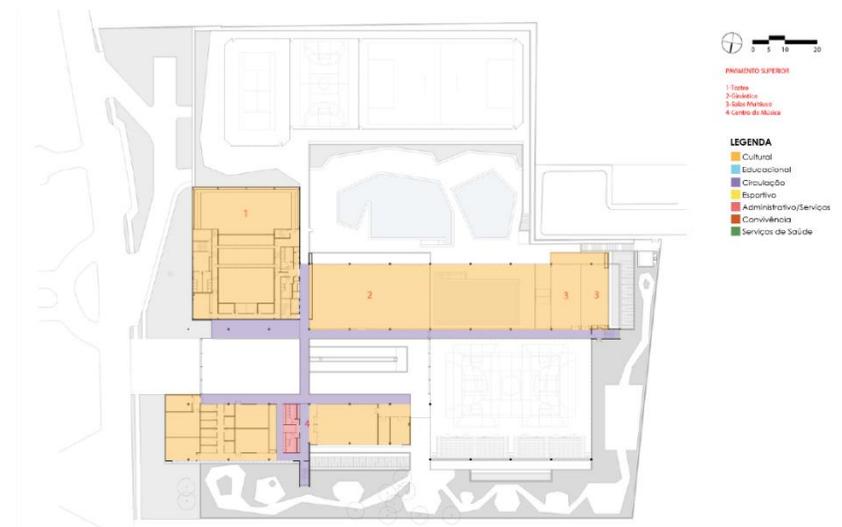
Planta Baixa SESC Guarulhos – Pav. Superior: estudo usos e zoneamento. (Archdaily, 2019 – editado pelo autor)
